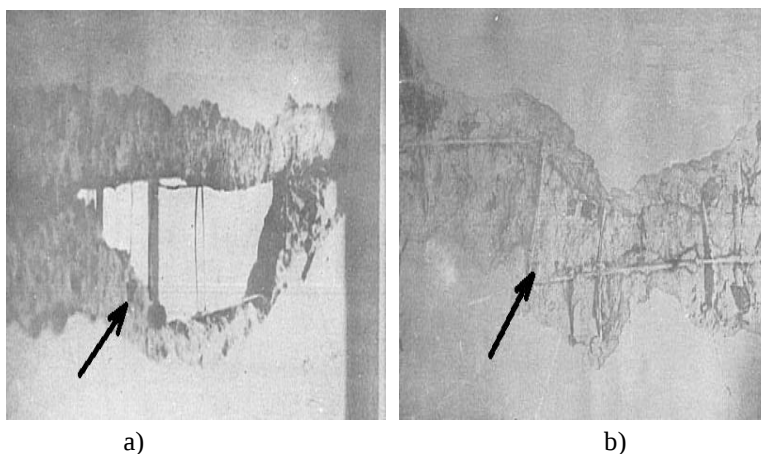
a) Distrugerea unei diafragme din beton; b) Fisuri și crăpături orizontale cu expulzarea stratului de acoperire cu beton la diafragme din beton [1]
